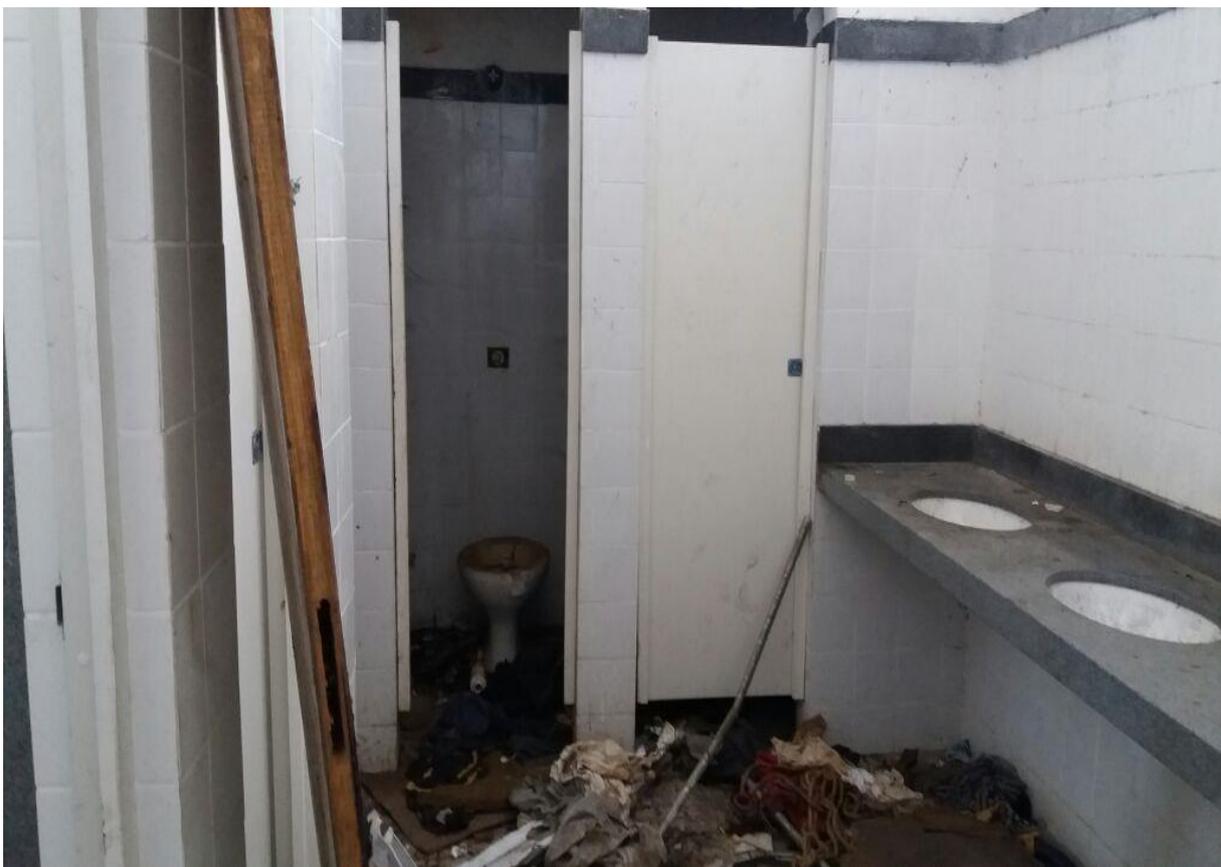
Banheiro localizado debaixo do Viaduto Santa Tereza
